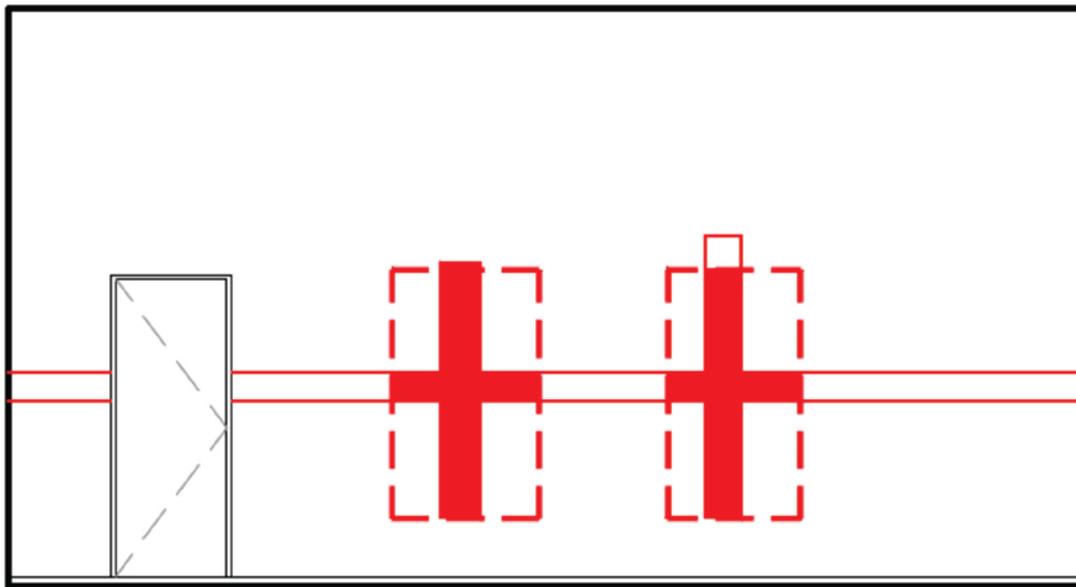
Elevação da prospecção arquitetônica 9 na parede
